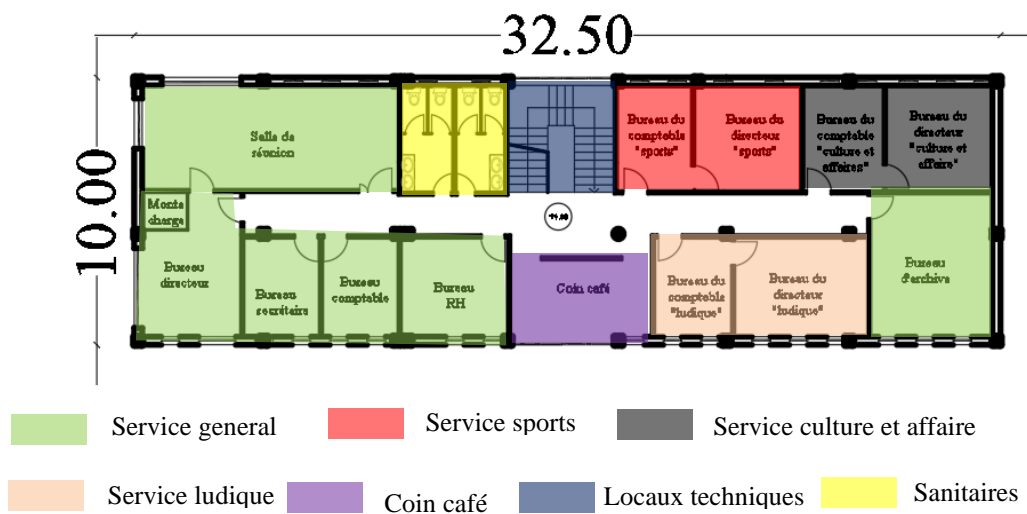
Plan R+1 Administration. (Source : Auteur)
